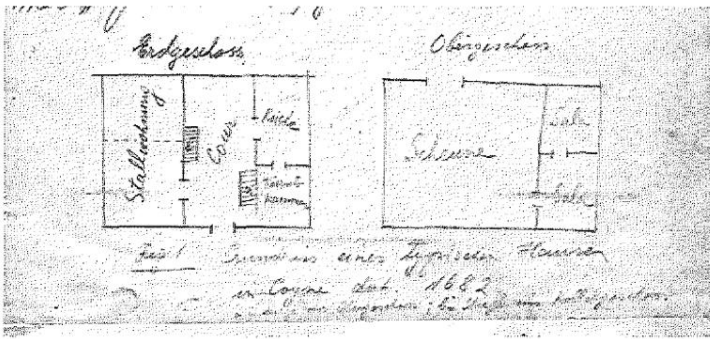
Grundriss eines typischen Hauses in Cognac, dat. 1682
